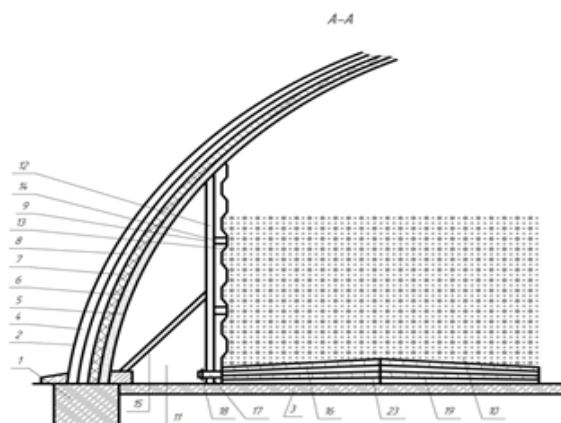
План картофелехранилища с воздуховодом в виде усеченной треугольной пирамиды
